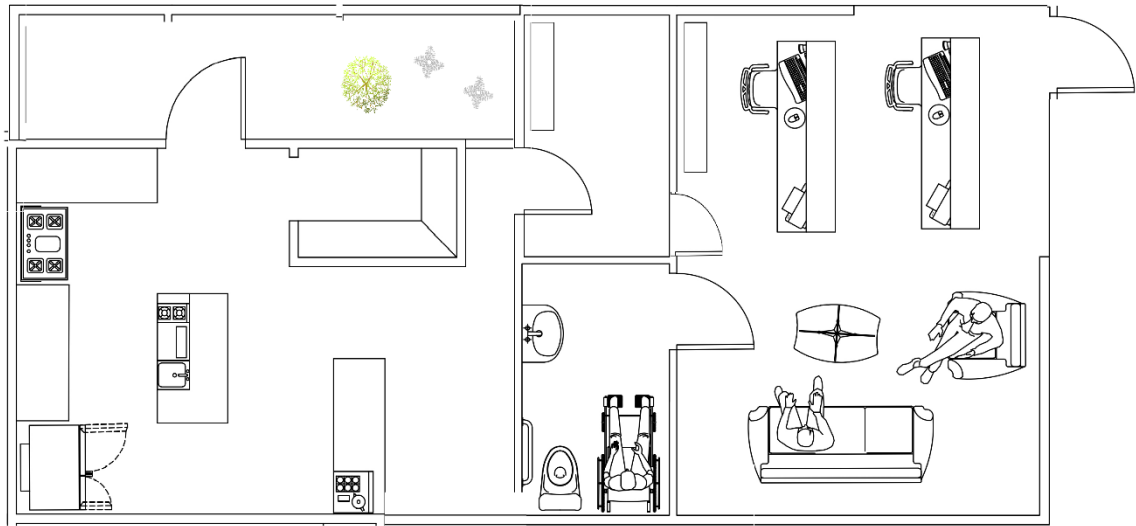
Planta arquitectónica de la oficina de Boost Détox.
